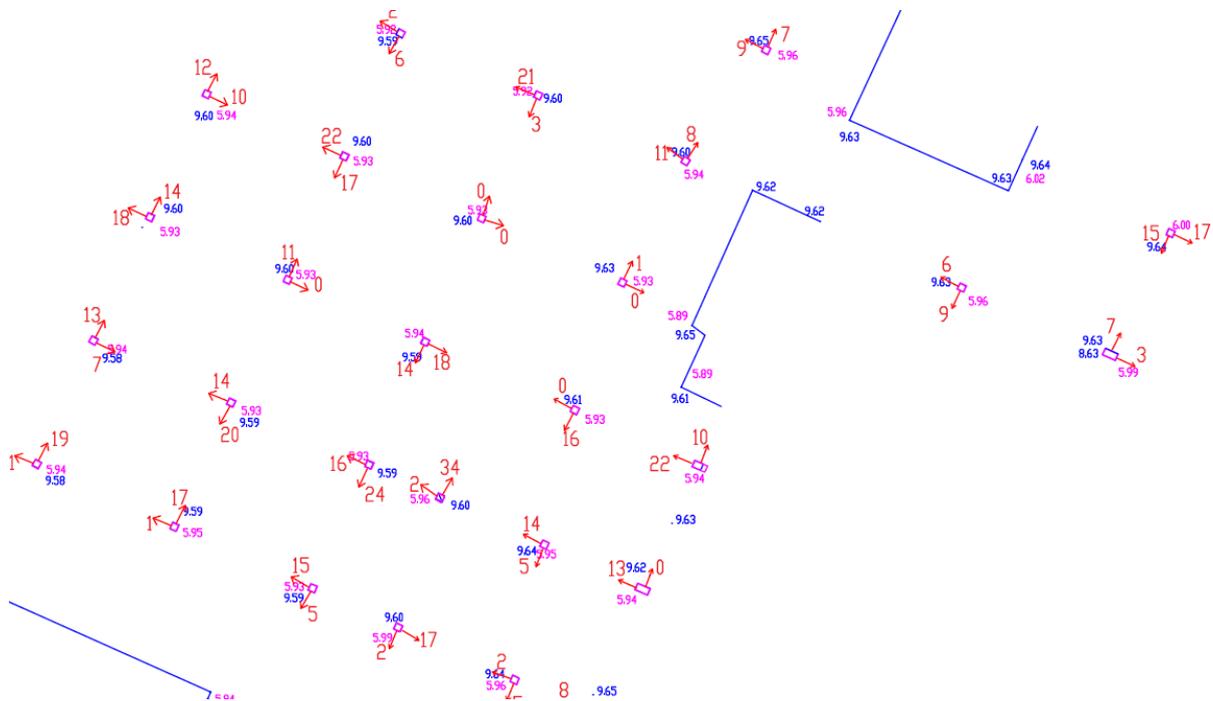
Фрагмент исполнительной схемы отклонения колонн 2 этажа от вертикали
